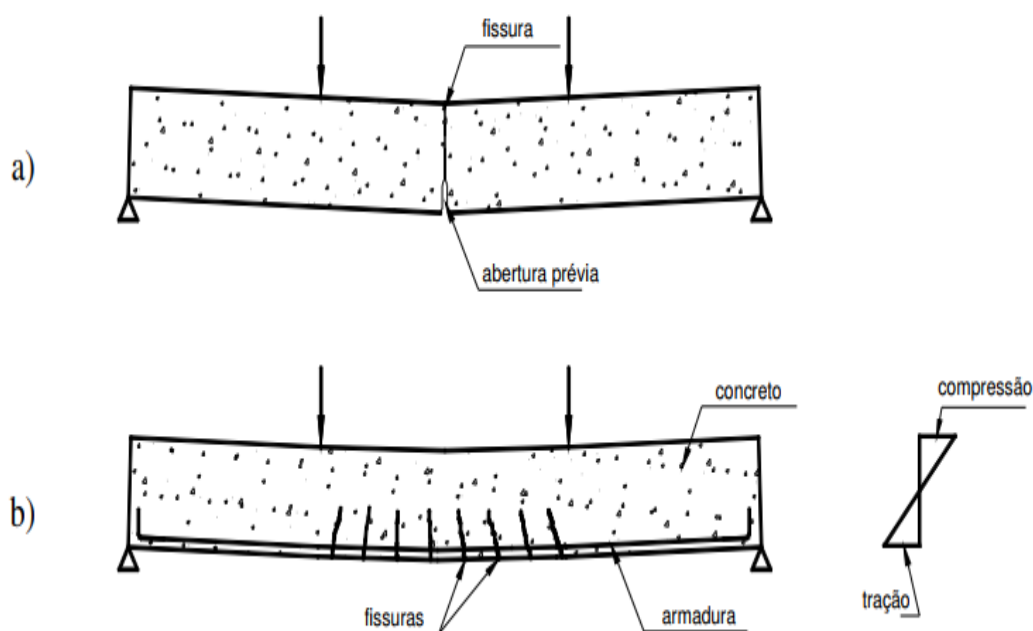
Viga de concreto: a) sem armadura; b) com armadura.
